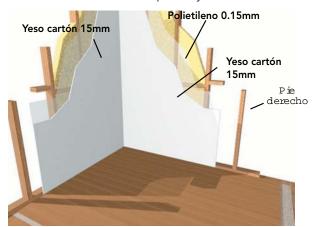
27: Fijación de la barrera de vapor en un tabique perimetral.
